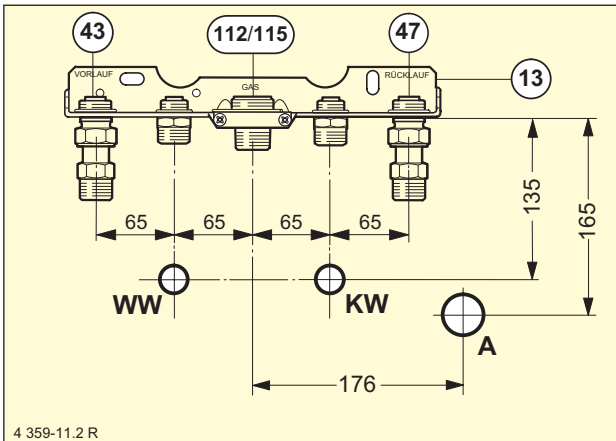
Aufputzanschlüsse mit Wandabstand 60 mm
